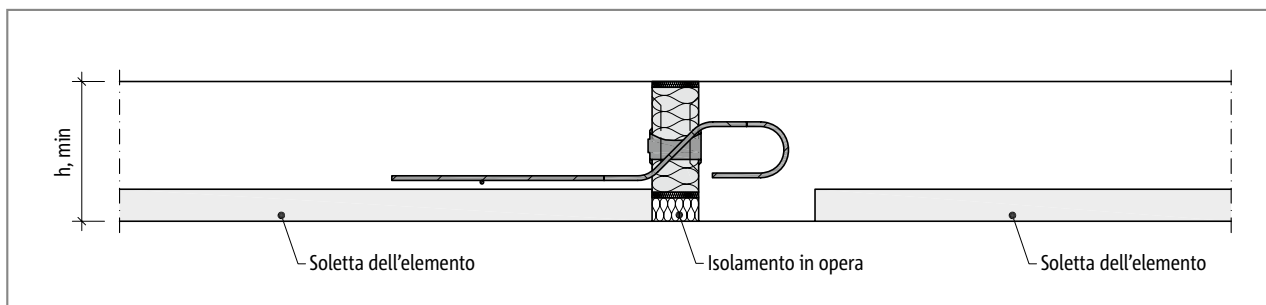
Schöck Isokorb® T tipo QL, QP: solaio prefabbricato con Isokorb® T tipo QL/QP sovrapposto
